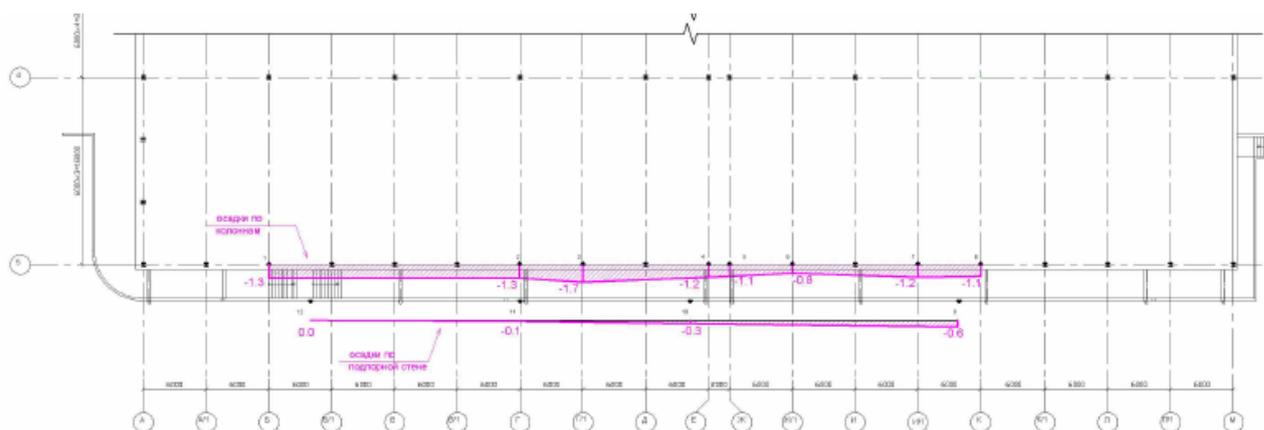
Эпюры осадок фундаментов колонн и подпорной стены
